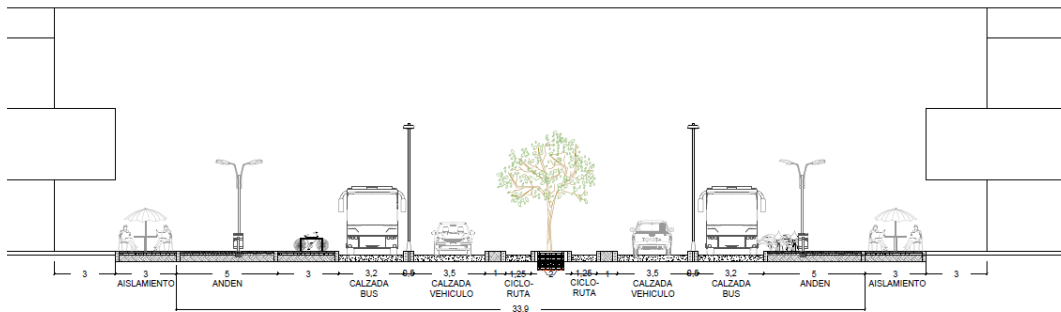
Perfil vial propuesto para las vías tipo V4.
